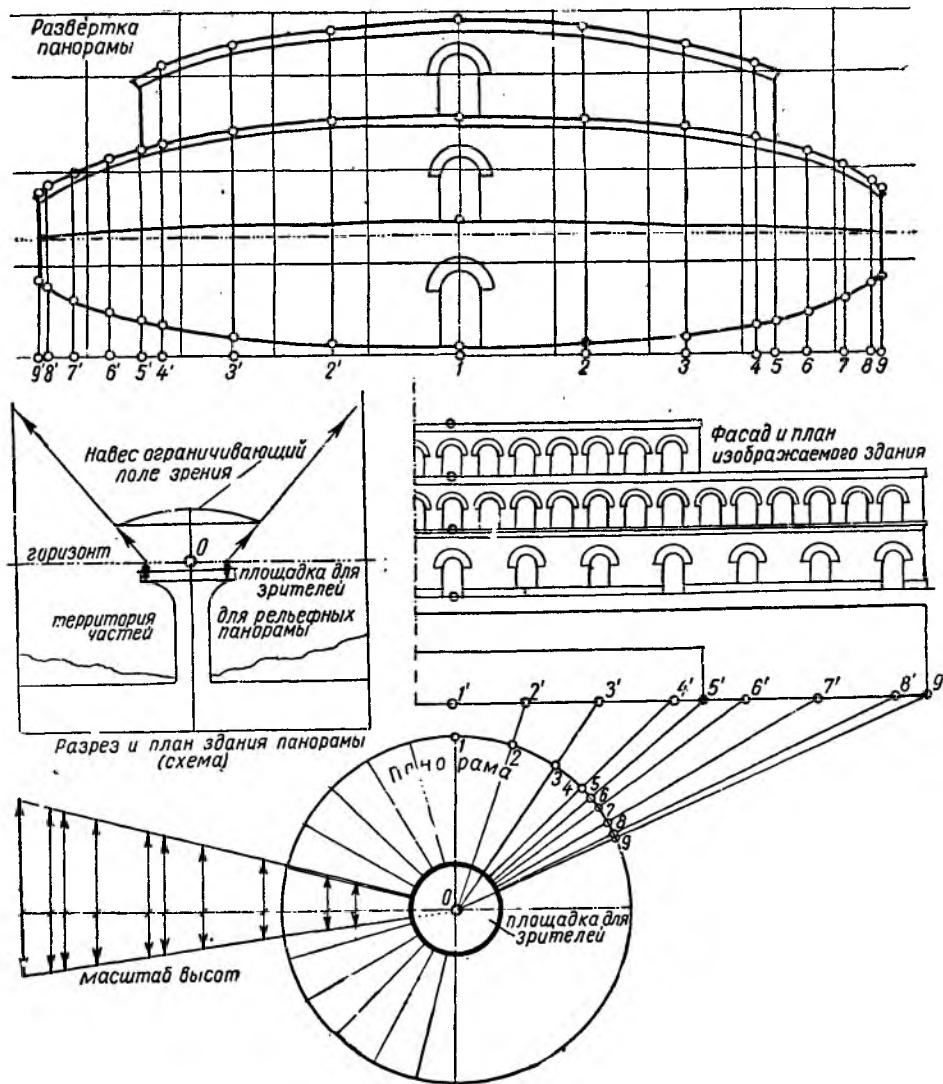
Схема устройства панорамы и процесс ее исполнения по способу развертки поверхности цилиндра
